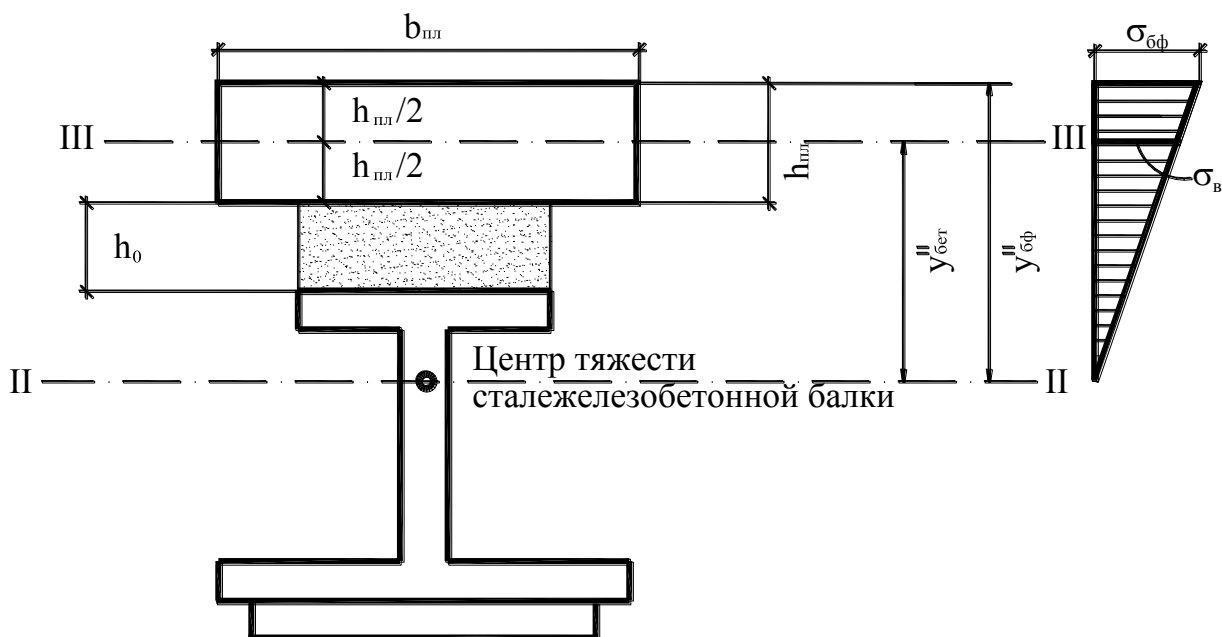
Схема к определению напряжений в железобетонной плите при её упругой работе
